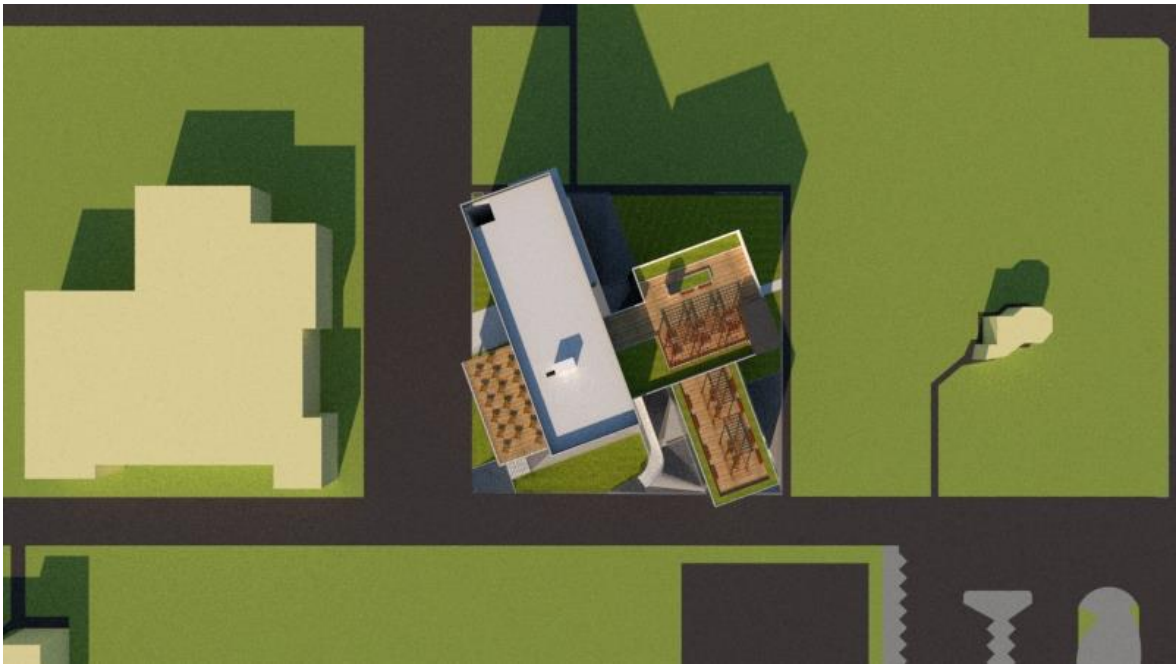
Vista en planta del contexto inmediato del proyecto.
